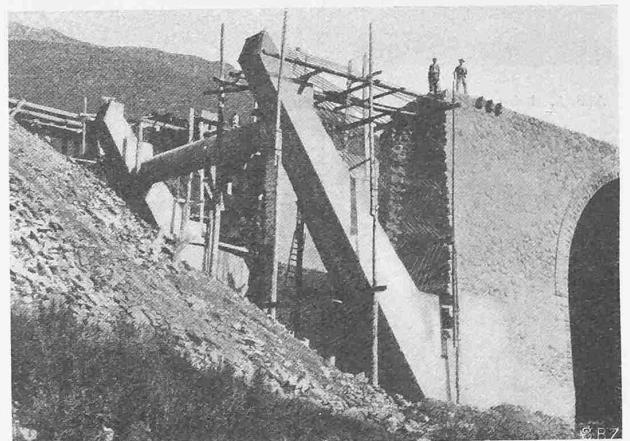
Eisenbetonkonsolen der Lavinabrücke.
